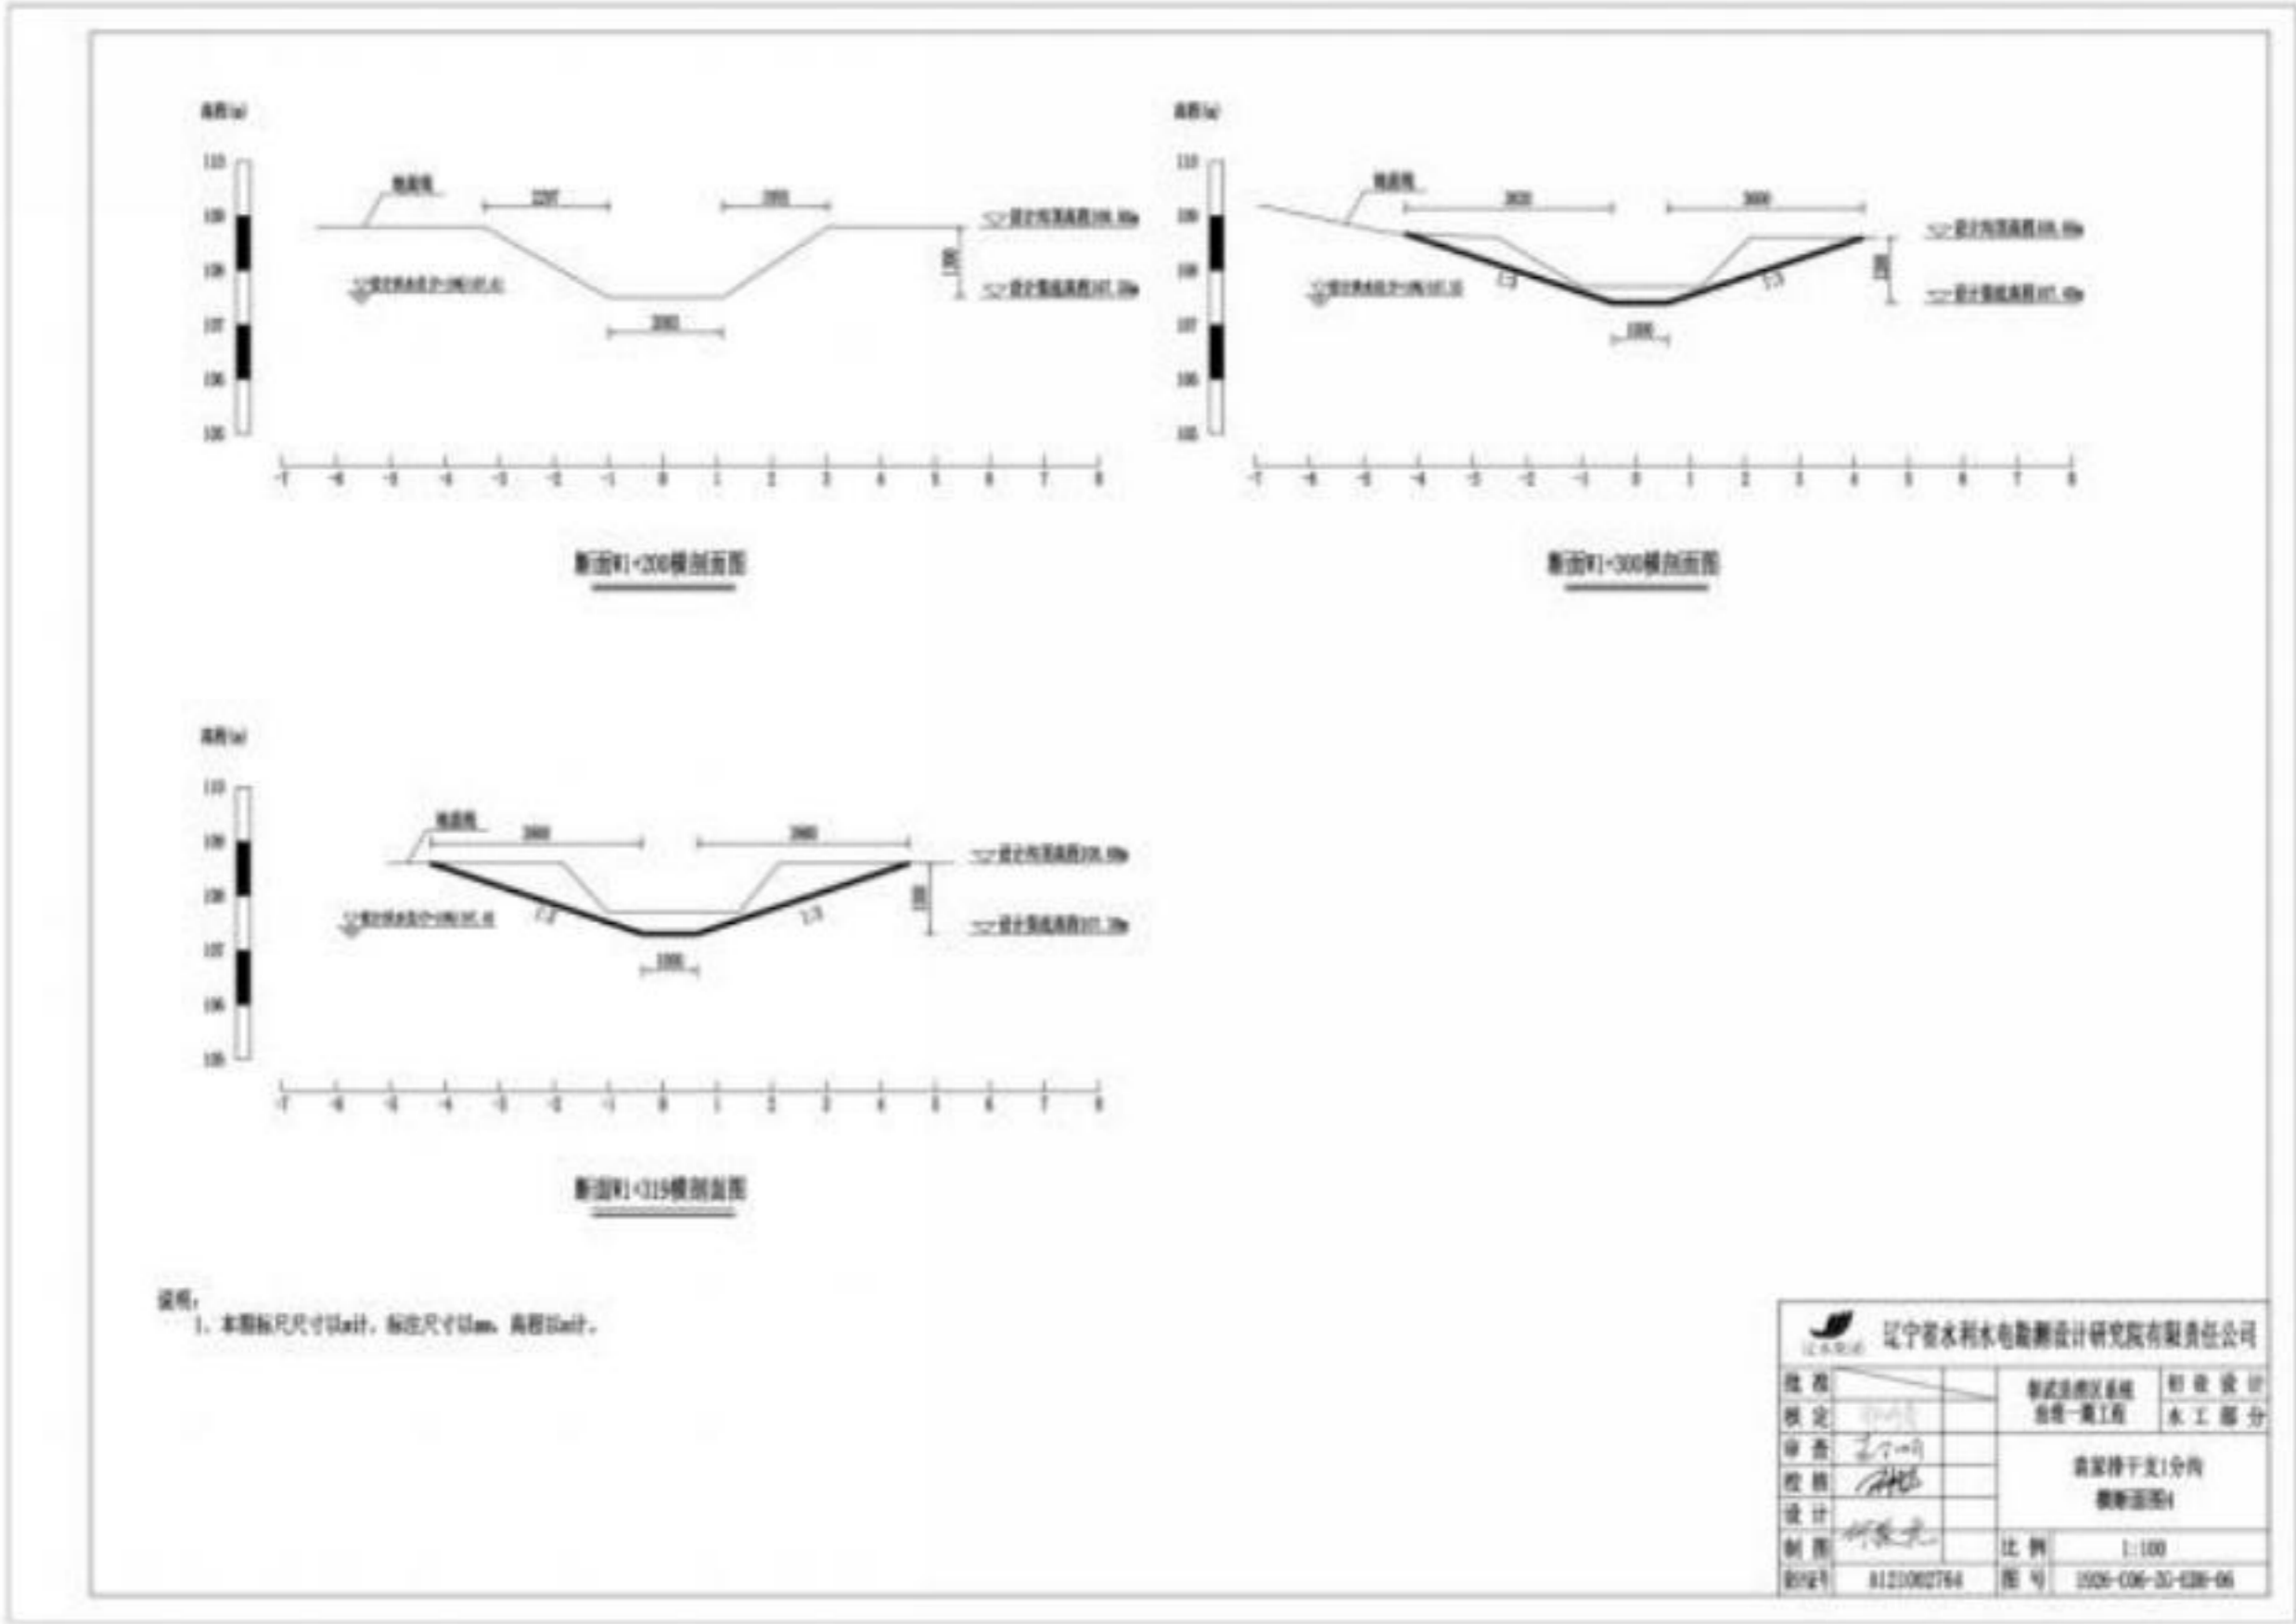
（4） 二道河子乡袁家排干支 1 分沟剖面图
